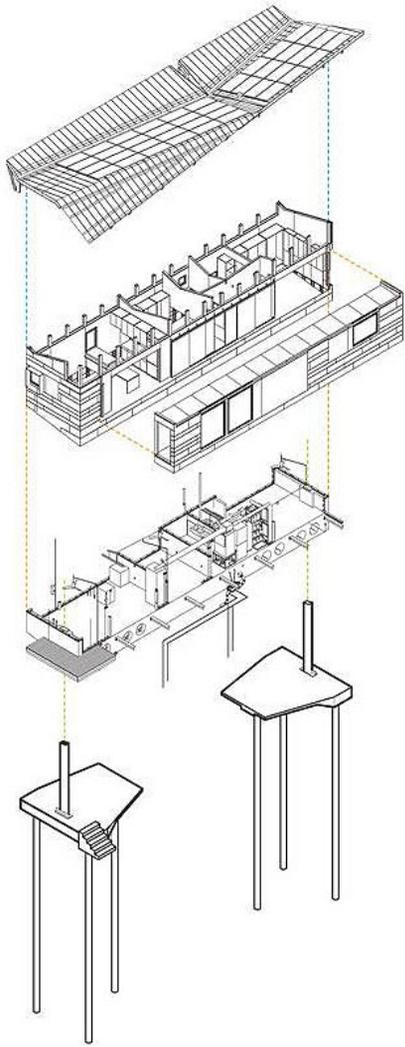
101] Vista de una vivienda autoconstruida modelo Shotguns Houses.
